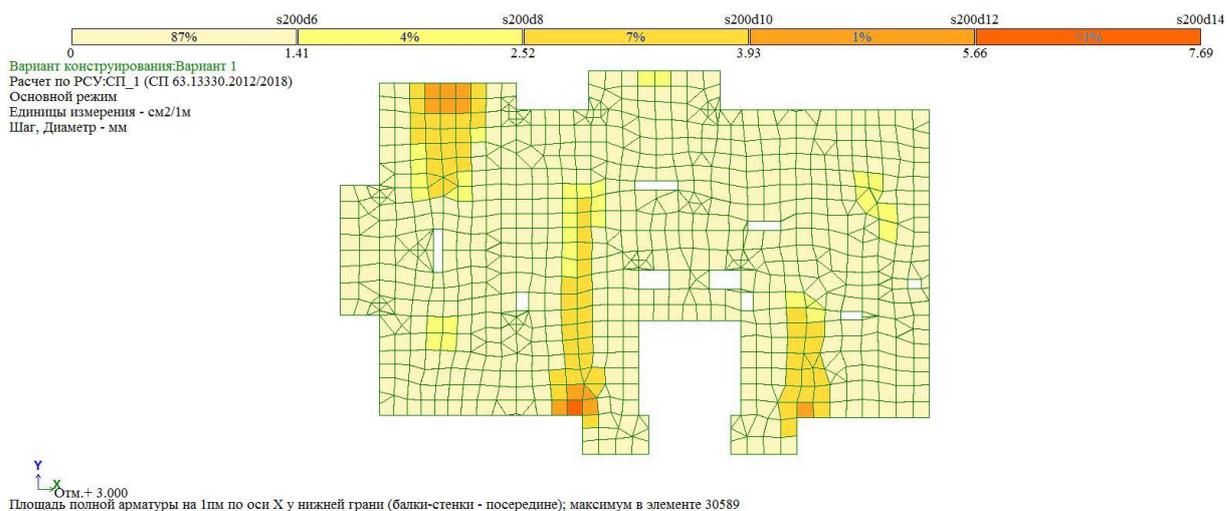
Нижняя арматура в плите перекрытия вдоль оси X
